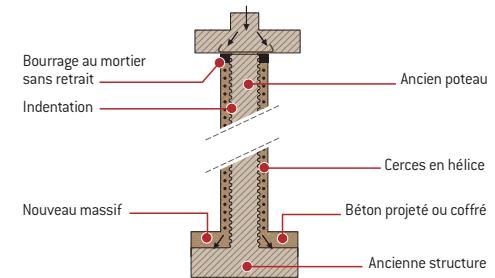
Chemisage en béton armé d'un poteau + fondation renforcée [coupe transversale]
